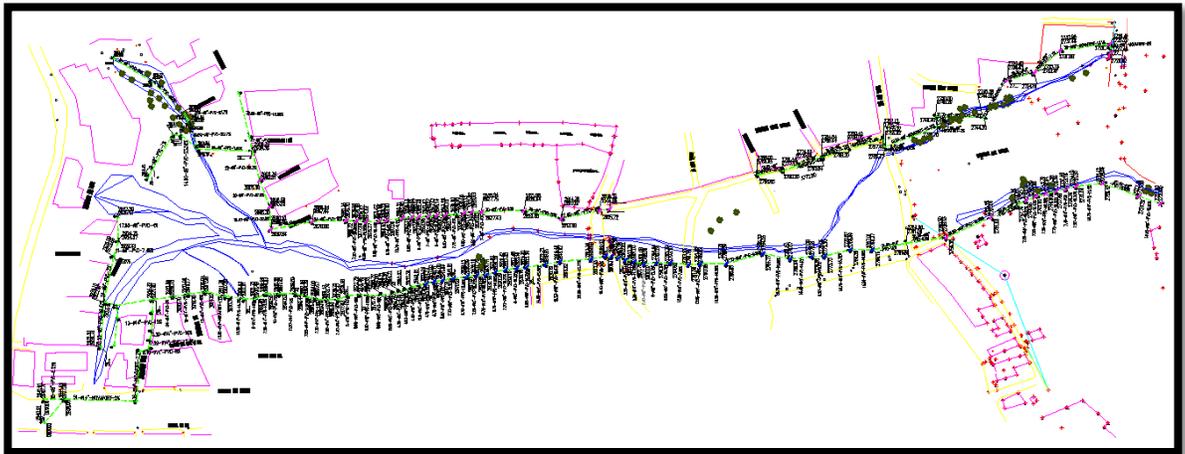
Planta de la red de alcantarillado zanjón de La Estrella tramo 1 – quintas del sur
